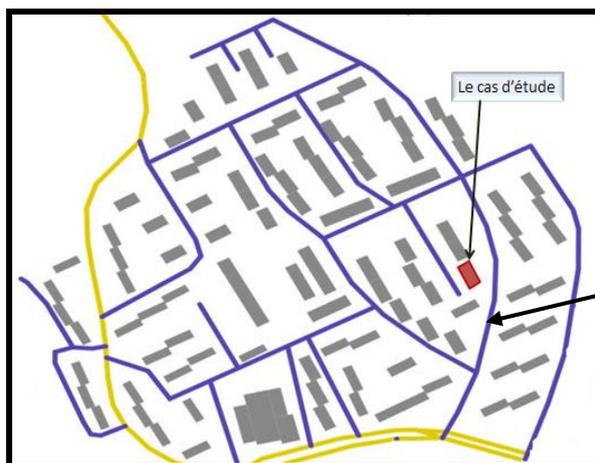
plan de masse de la cité Aban Ramdan, (auteur)
